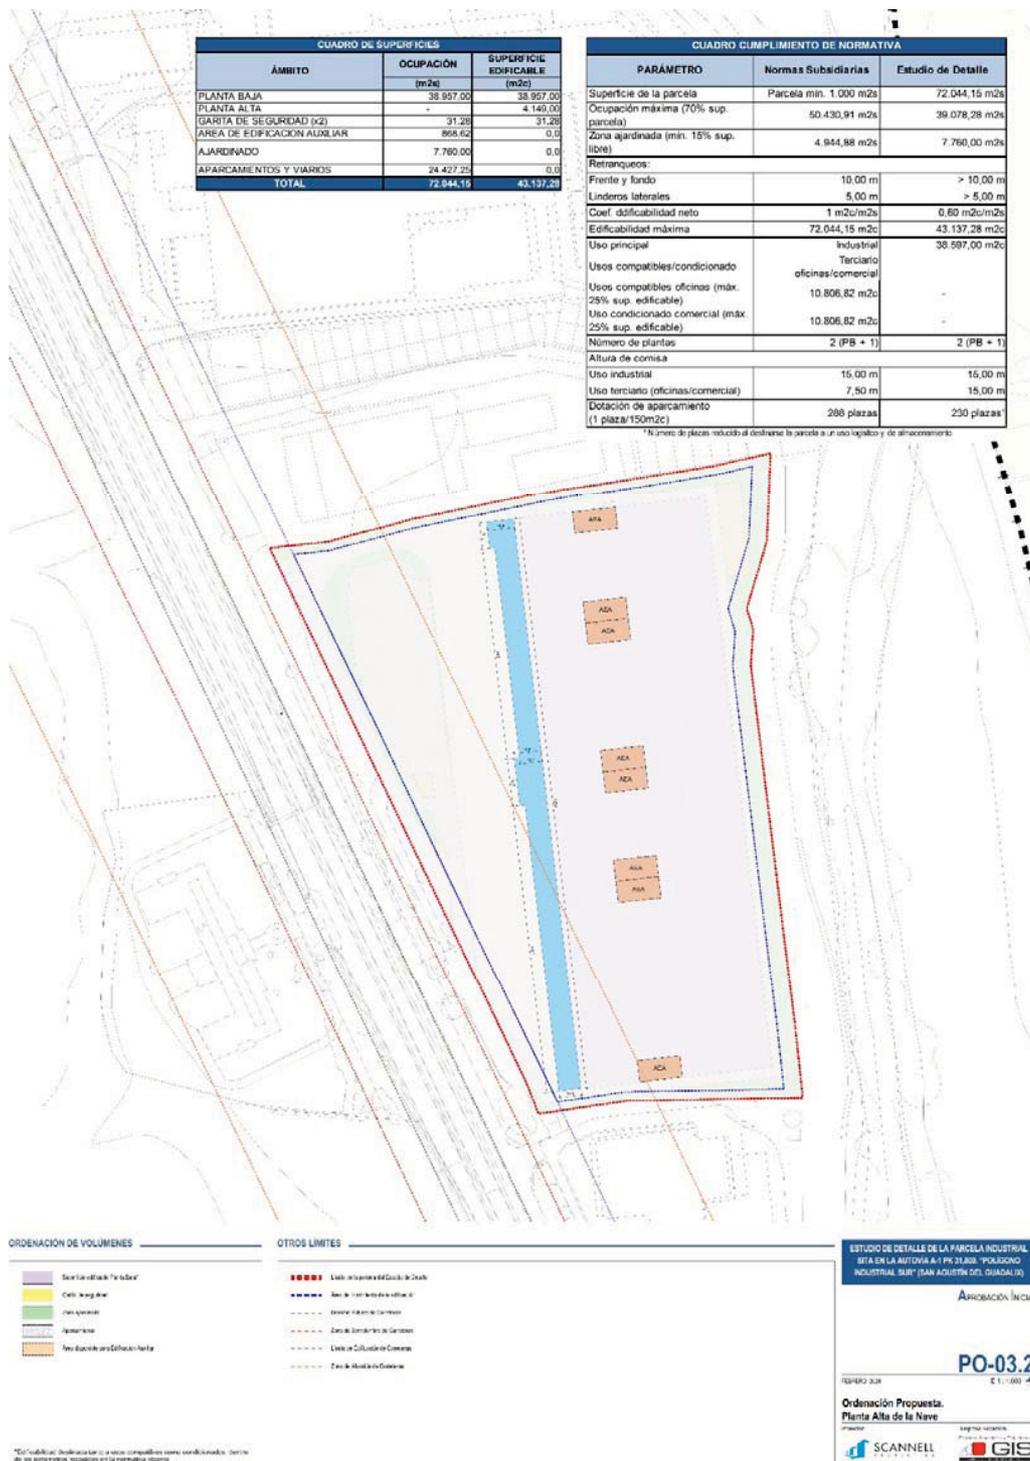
Plano de Ordenación Propuesta. Planta Alta
